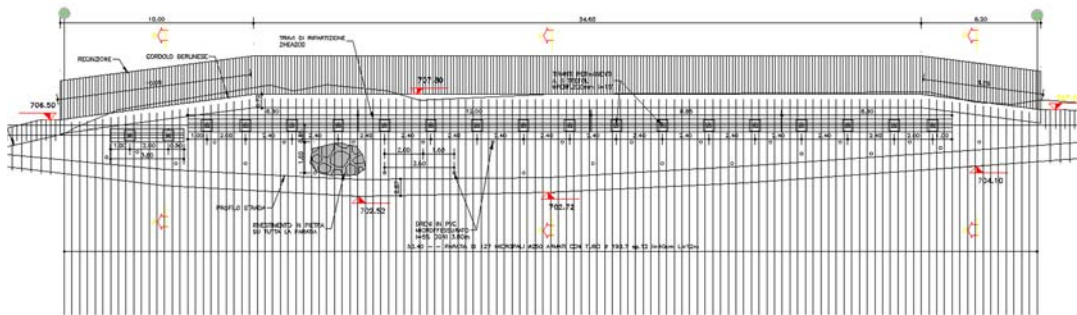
Prospetto berlinese di collegamento alla viabilità esistente
